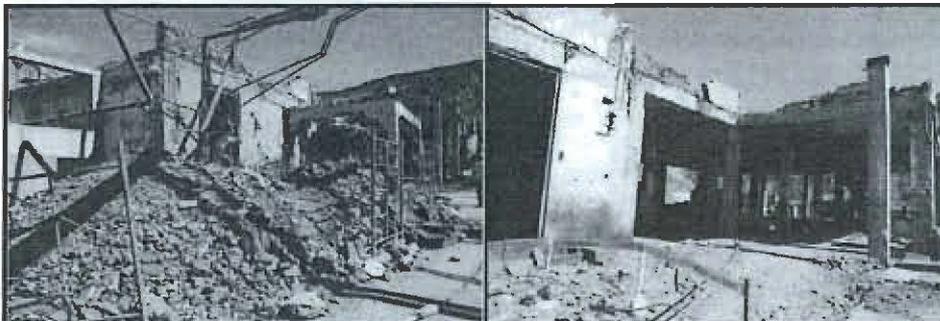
Estructuras de la planta de producción de harina residual desmontada por el administrado.
